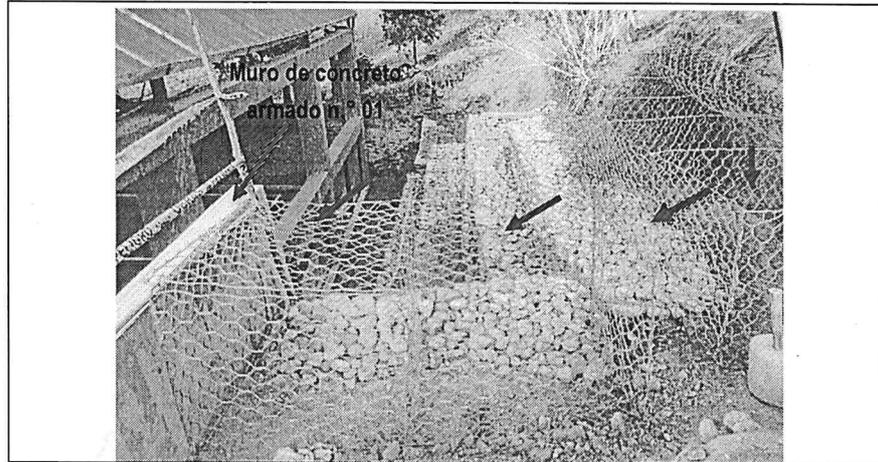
Se verifica que detrás del muro de concreto armado n.º 1, se colocó 2 cajas de gavión, ocasionando mayor carga al muro de contención.
